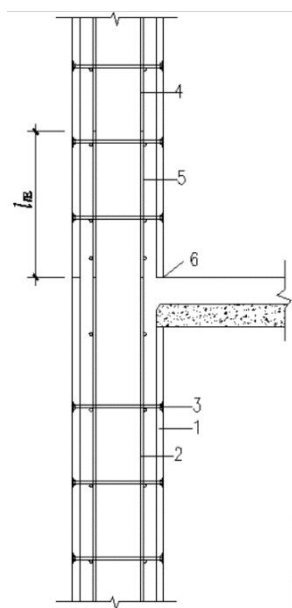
剪力墙竖向分布钢筋连接构造示意
